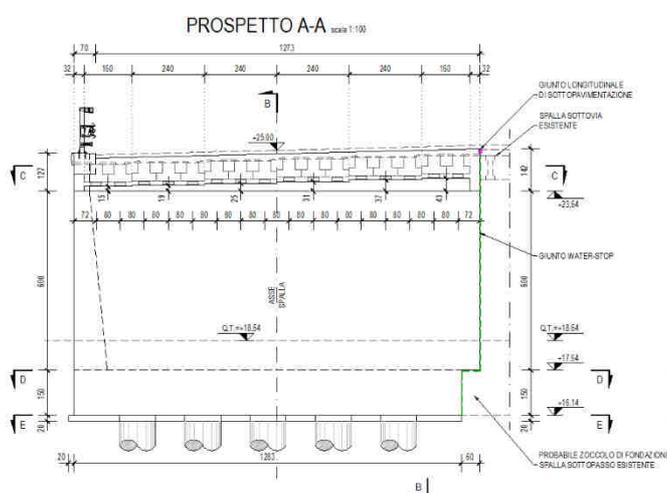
Prospetto spalla 1 impalcato est – Sottovia ferroviario km. 6+825
